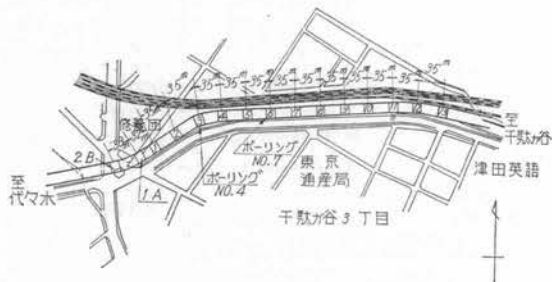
首都高速道路4号線414,415高架橋橋脚平面図
